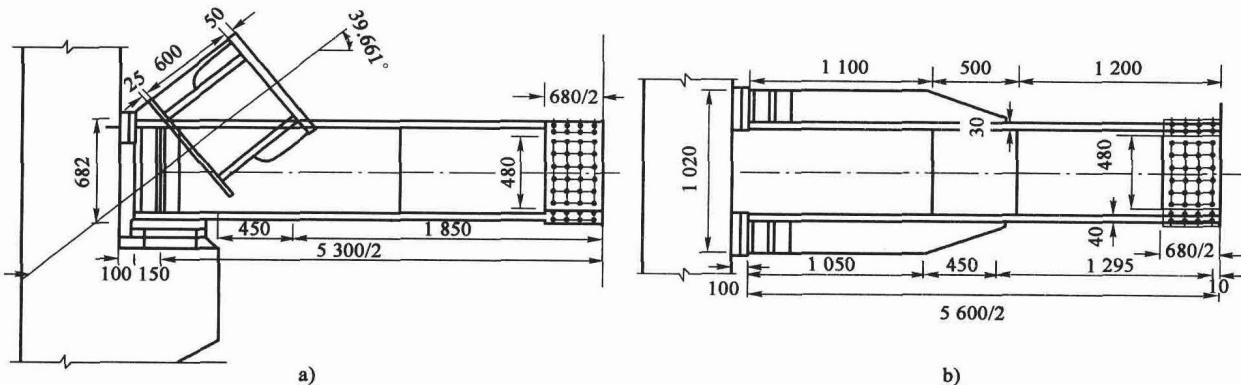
灌河大桥钢锚梁结构示意(尺寸单位:mm)
